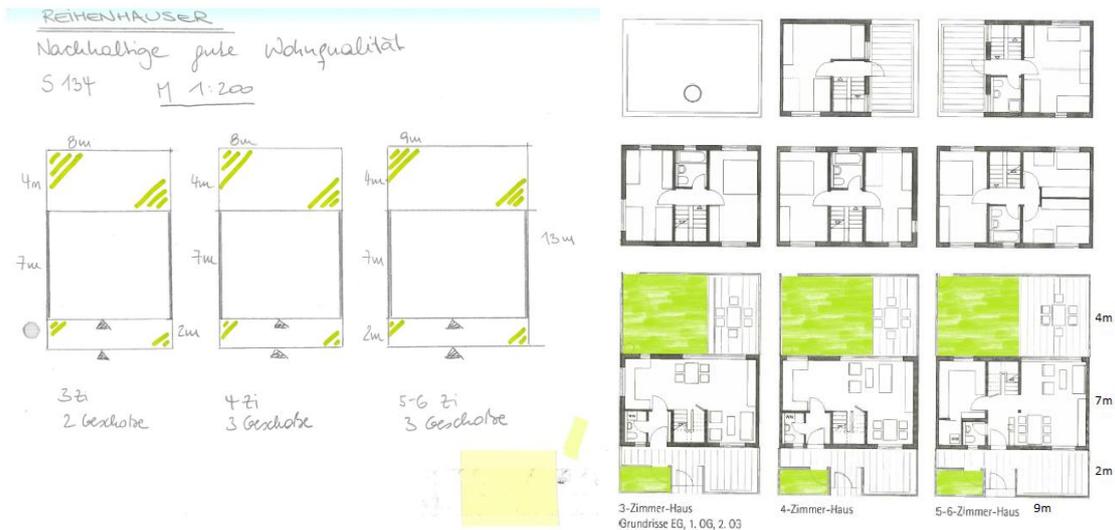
Grundrisse der Reihenhäuser (hellgelb)
